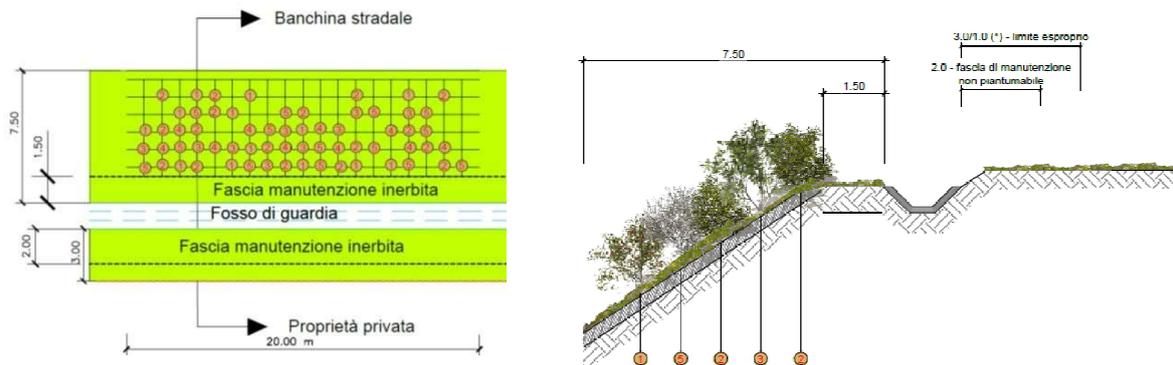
Griglia e Prospetto modulo PI-TR SCA 2
